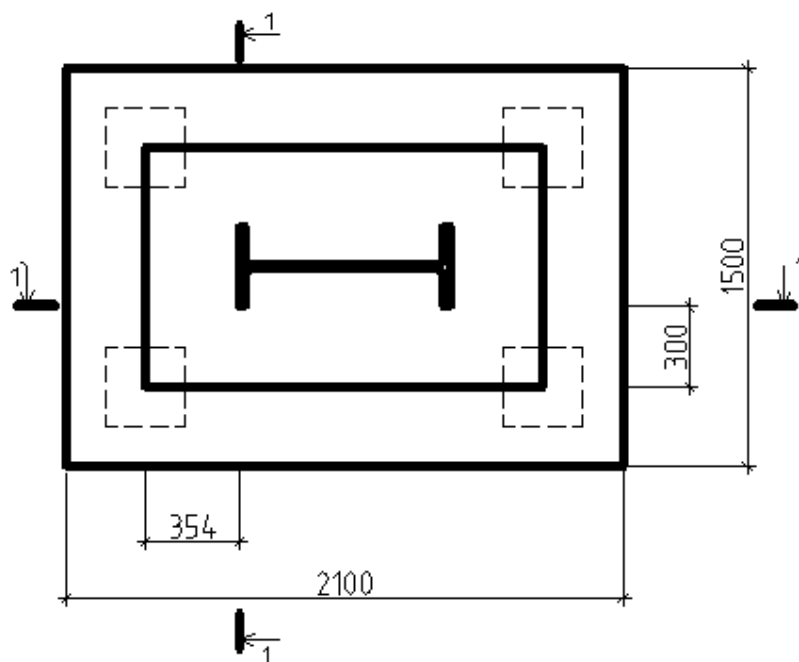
Схема к расчету арматуры плитной части свайного фундамента
